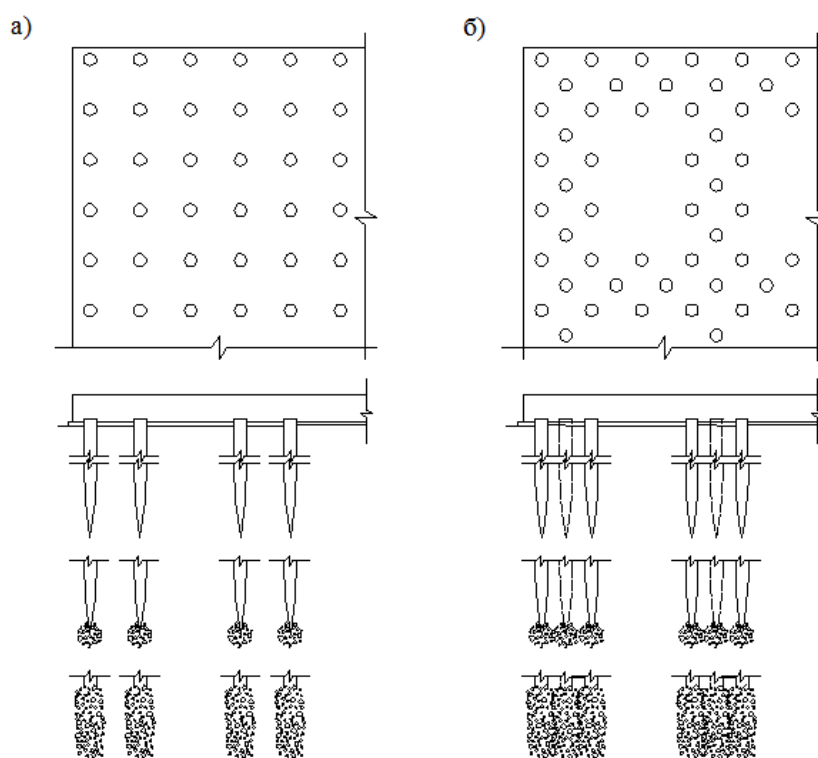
Конструктивные схемы монолитных плитных фундаментов на основаниях из НРСн сплошных свайных полей (а) и прерывистых (б).
